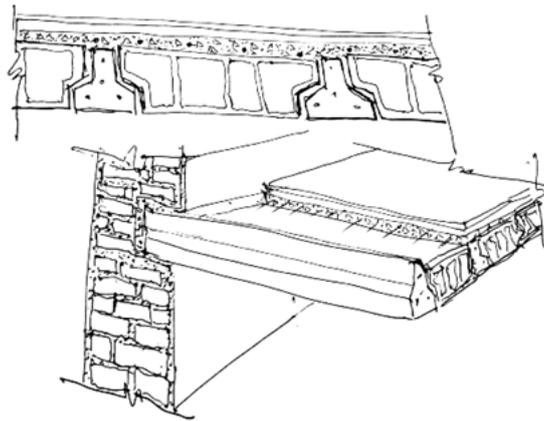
2 - Corte e perspectiva da laje aligeirada do pavimento e teto (parcial) da cozinha (Fonte: de autor).
